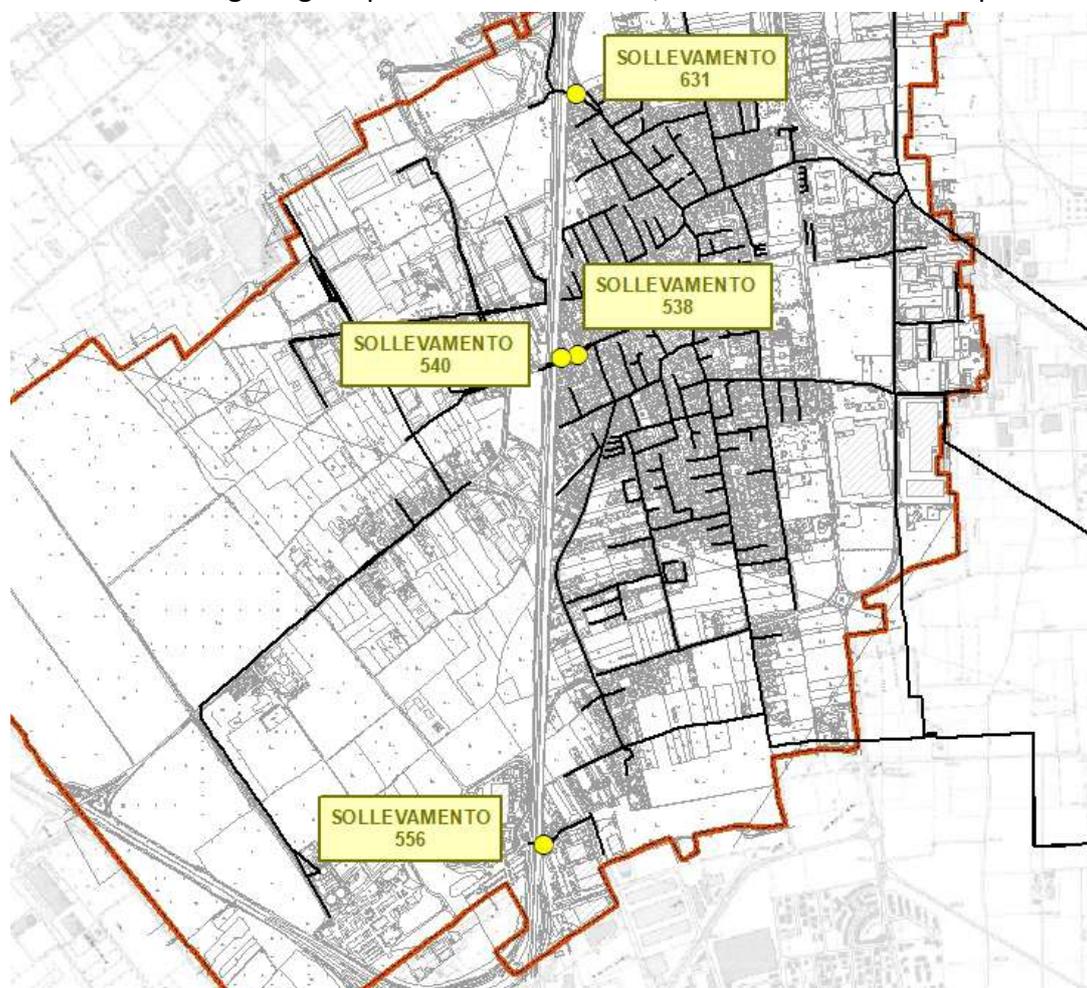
Inquadramento planimetrico – impianti di sollevamento
